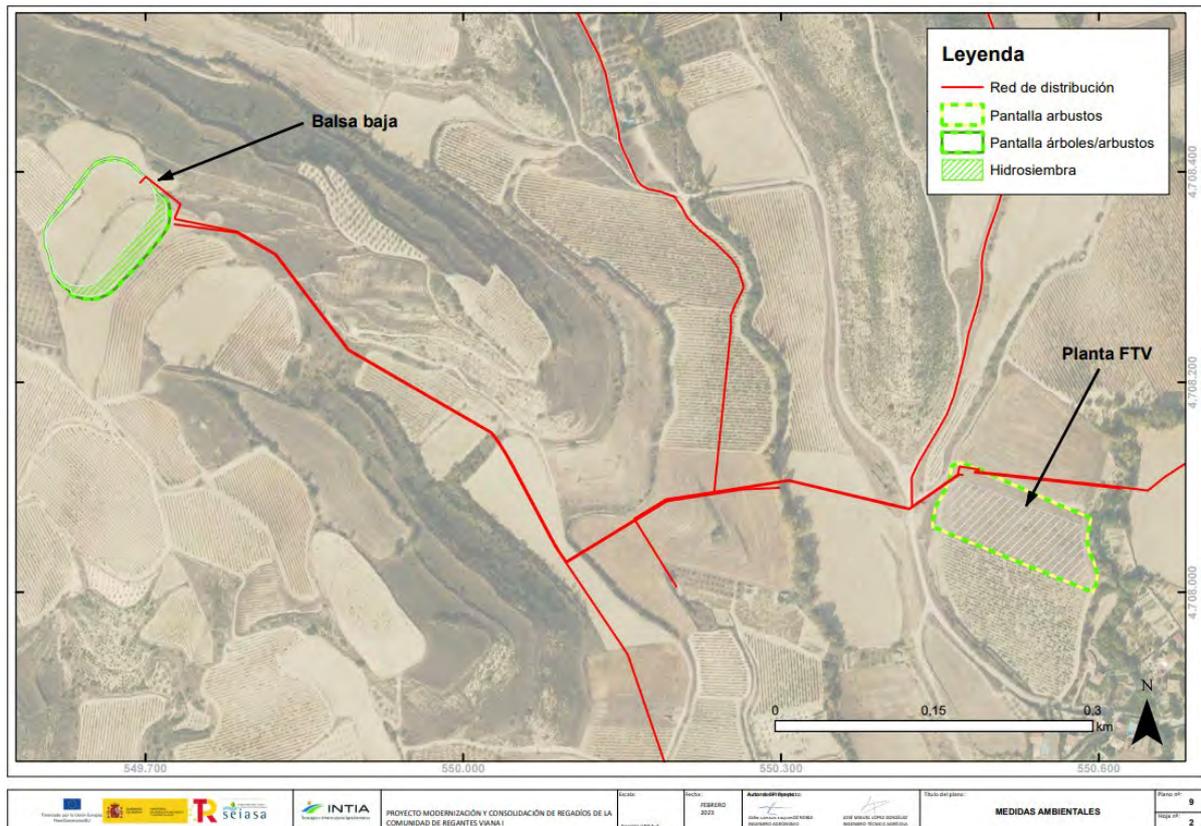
Mapa de Ubicación balsa baja y planta fotovoltaica
